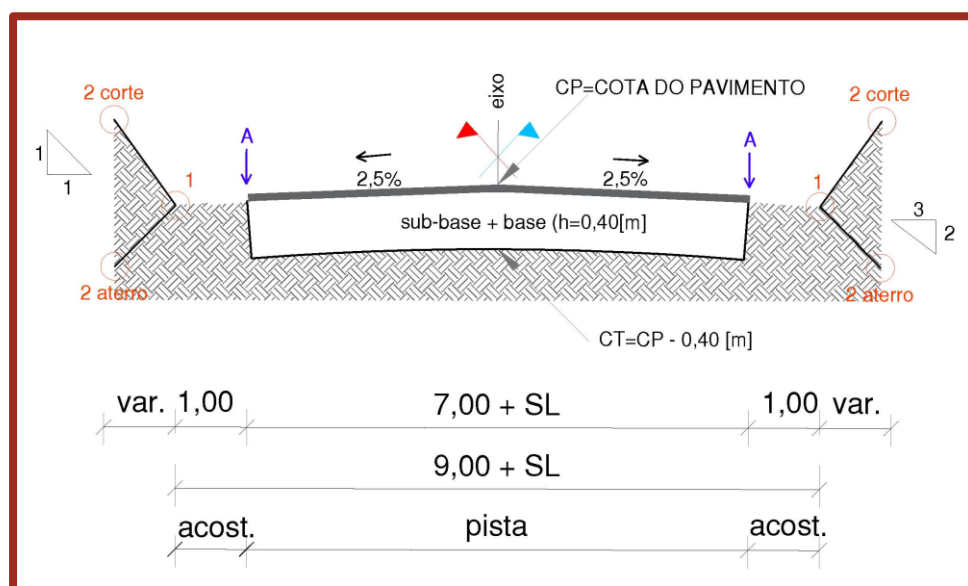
Ilustração para escavação da caixa de pavimento, exceto sobre tabuleiro da ponte 0+047,97 → 0+056,37 (média de 8,40m)
